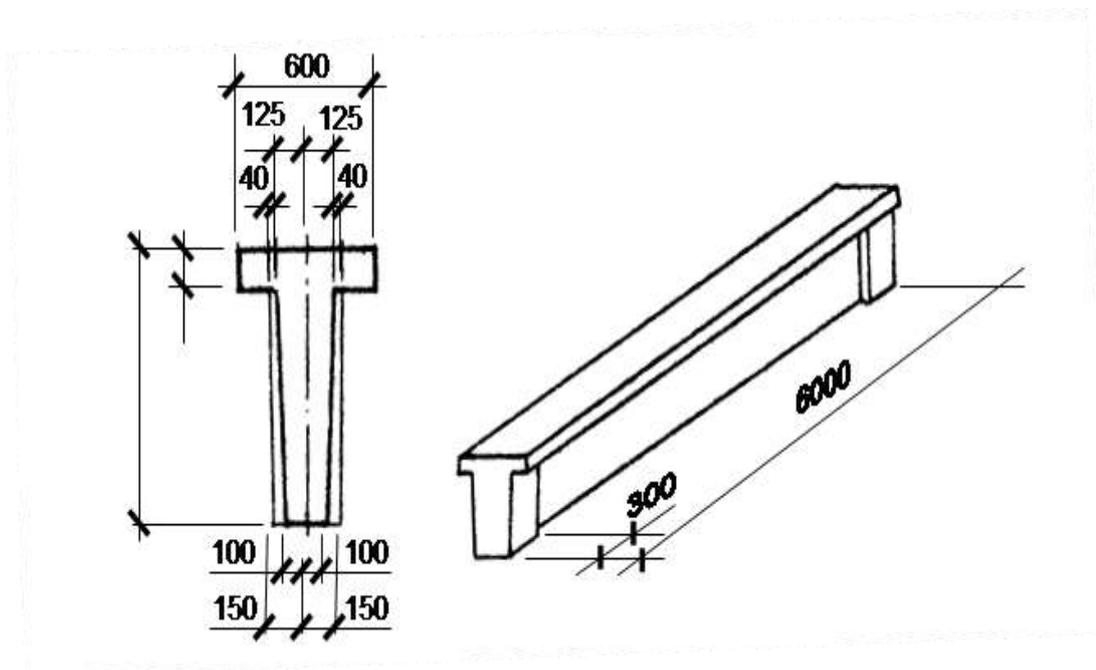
Подкрановая балка для шага колонн 6 м
